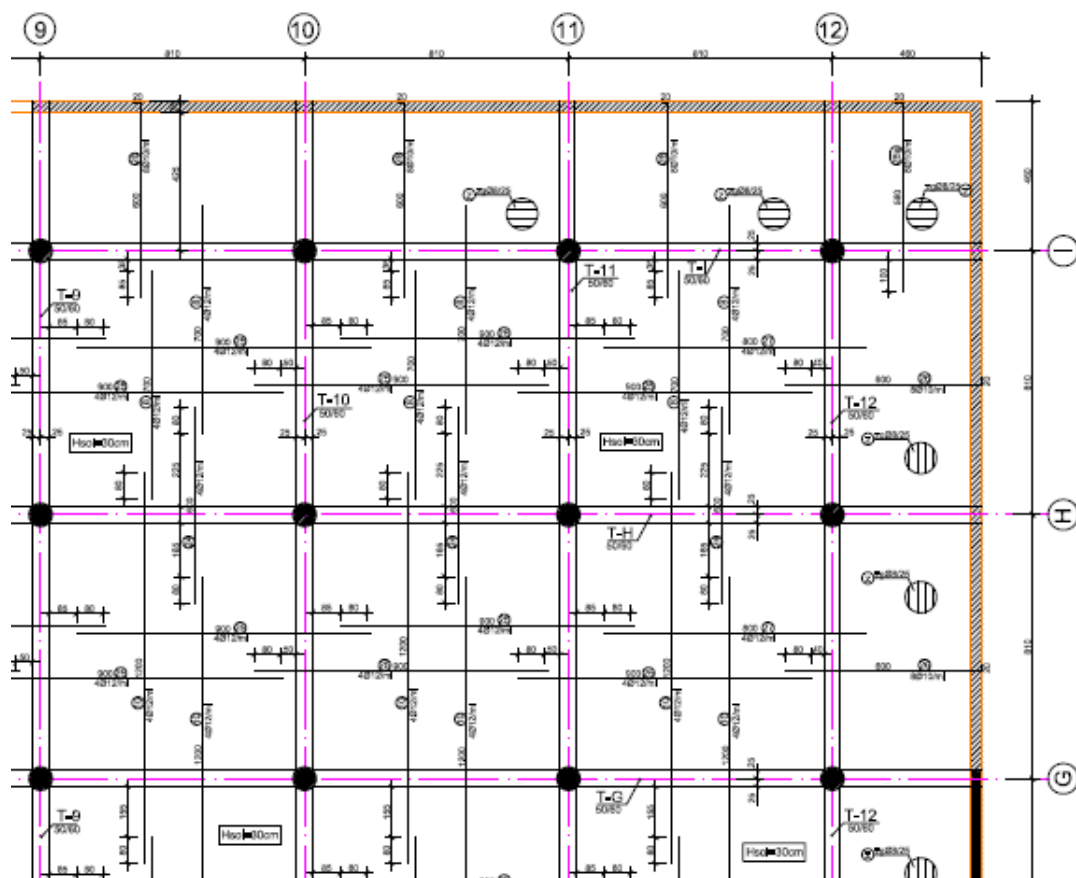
Një pjesë e planit të strukturave të parkimit nëntokësor, sheshi “Skënderbej”, Tiranë
